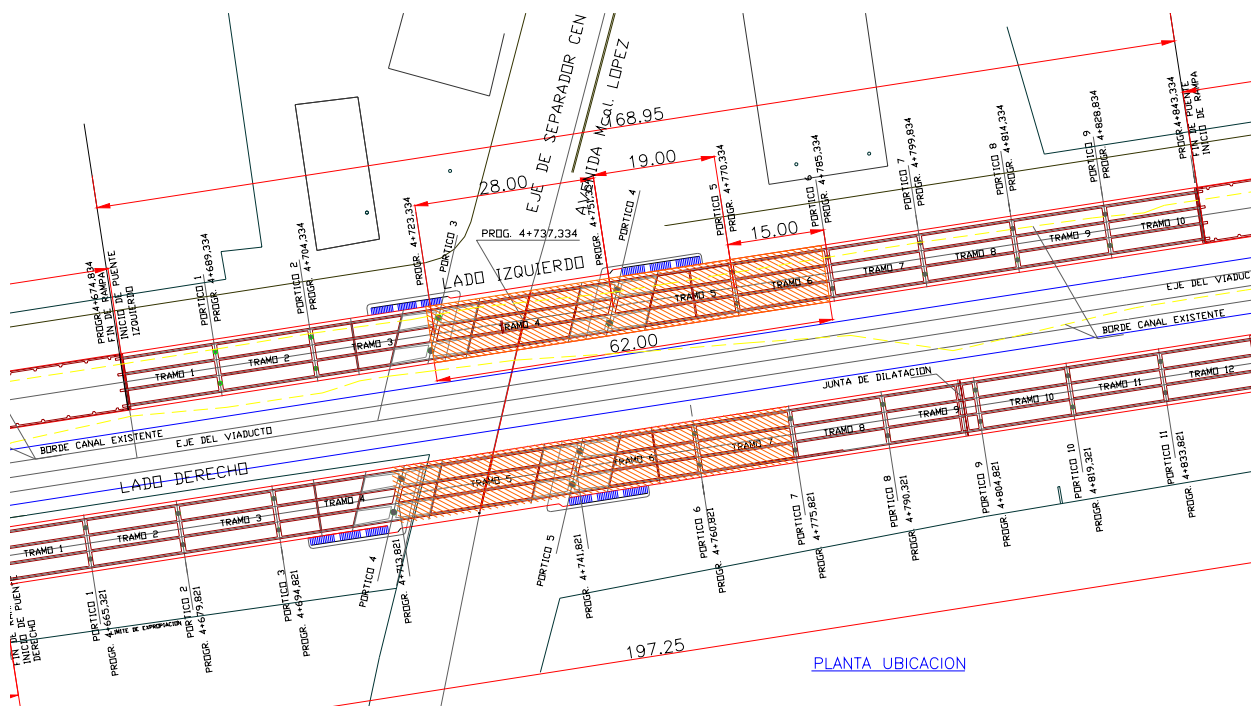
PLANTA DEL VIADUCTO IN SITU, CON LOS TRAMOS CAPACES DE SER CONSTRUÍDOS POR VEZ (LONGITUD = 124 M.), PARA LA COMPARACIÓN 2.
